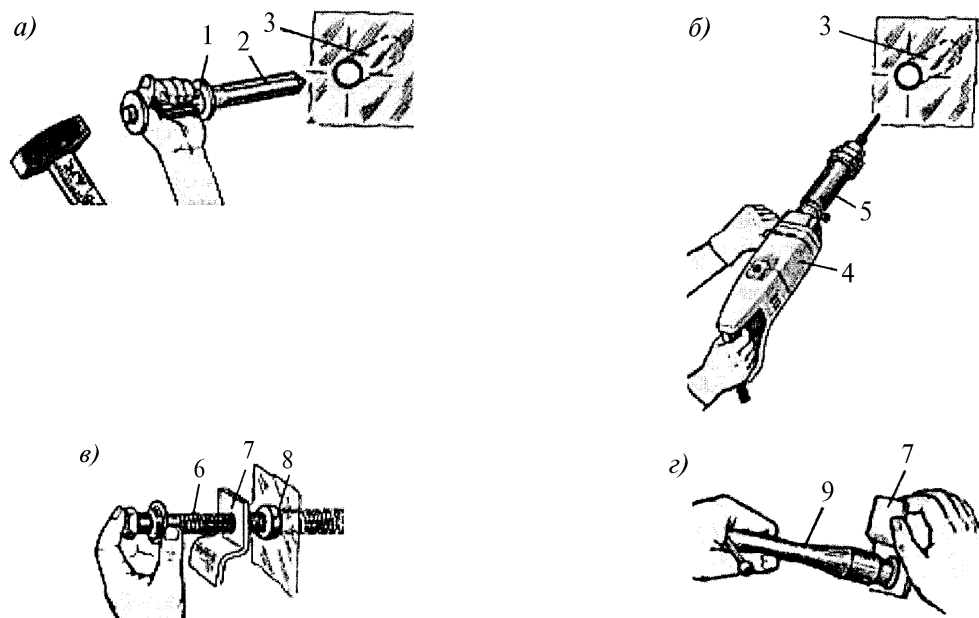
Установка крепежа водопроводов в строительных конструкциях
